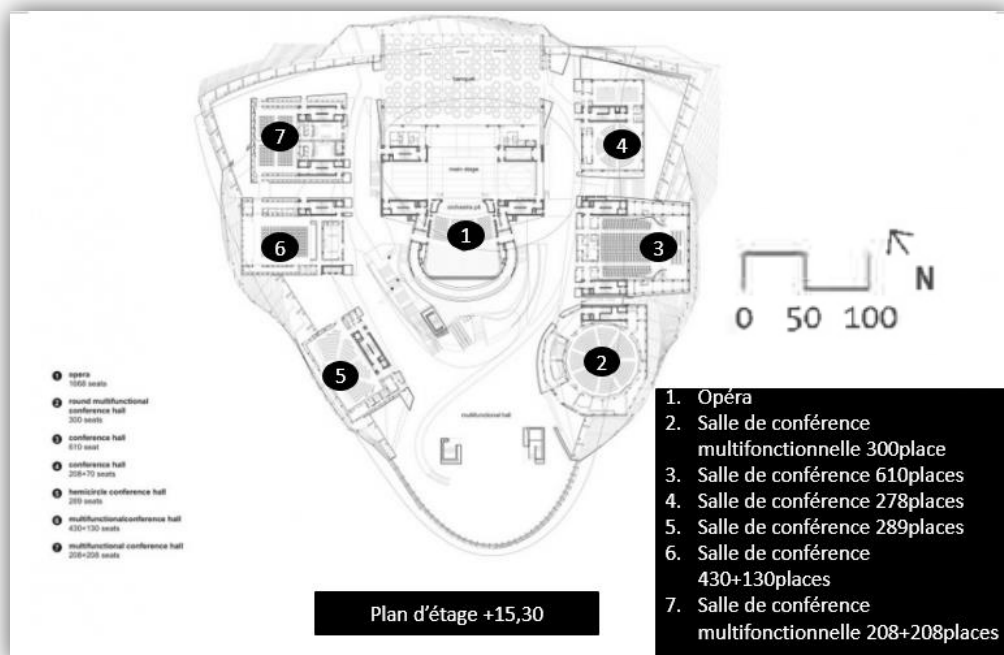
plan de 2<sup>ème</sup> étage.
